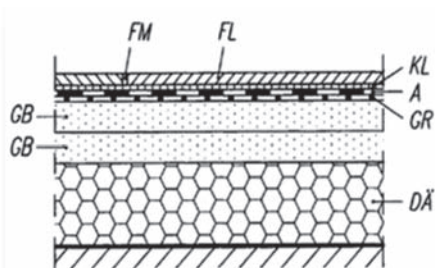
Fußbodenaufbau und Abdichtung in der Fläche [7.12]
